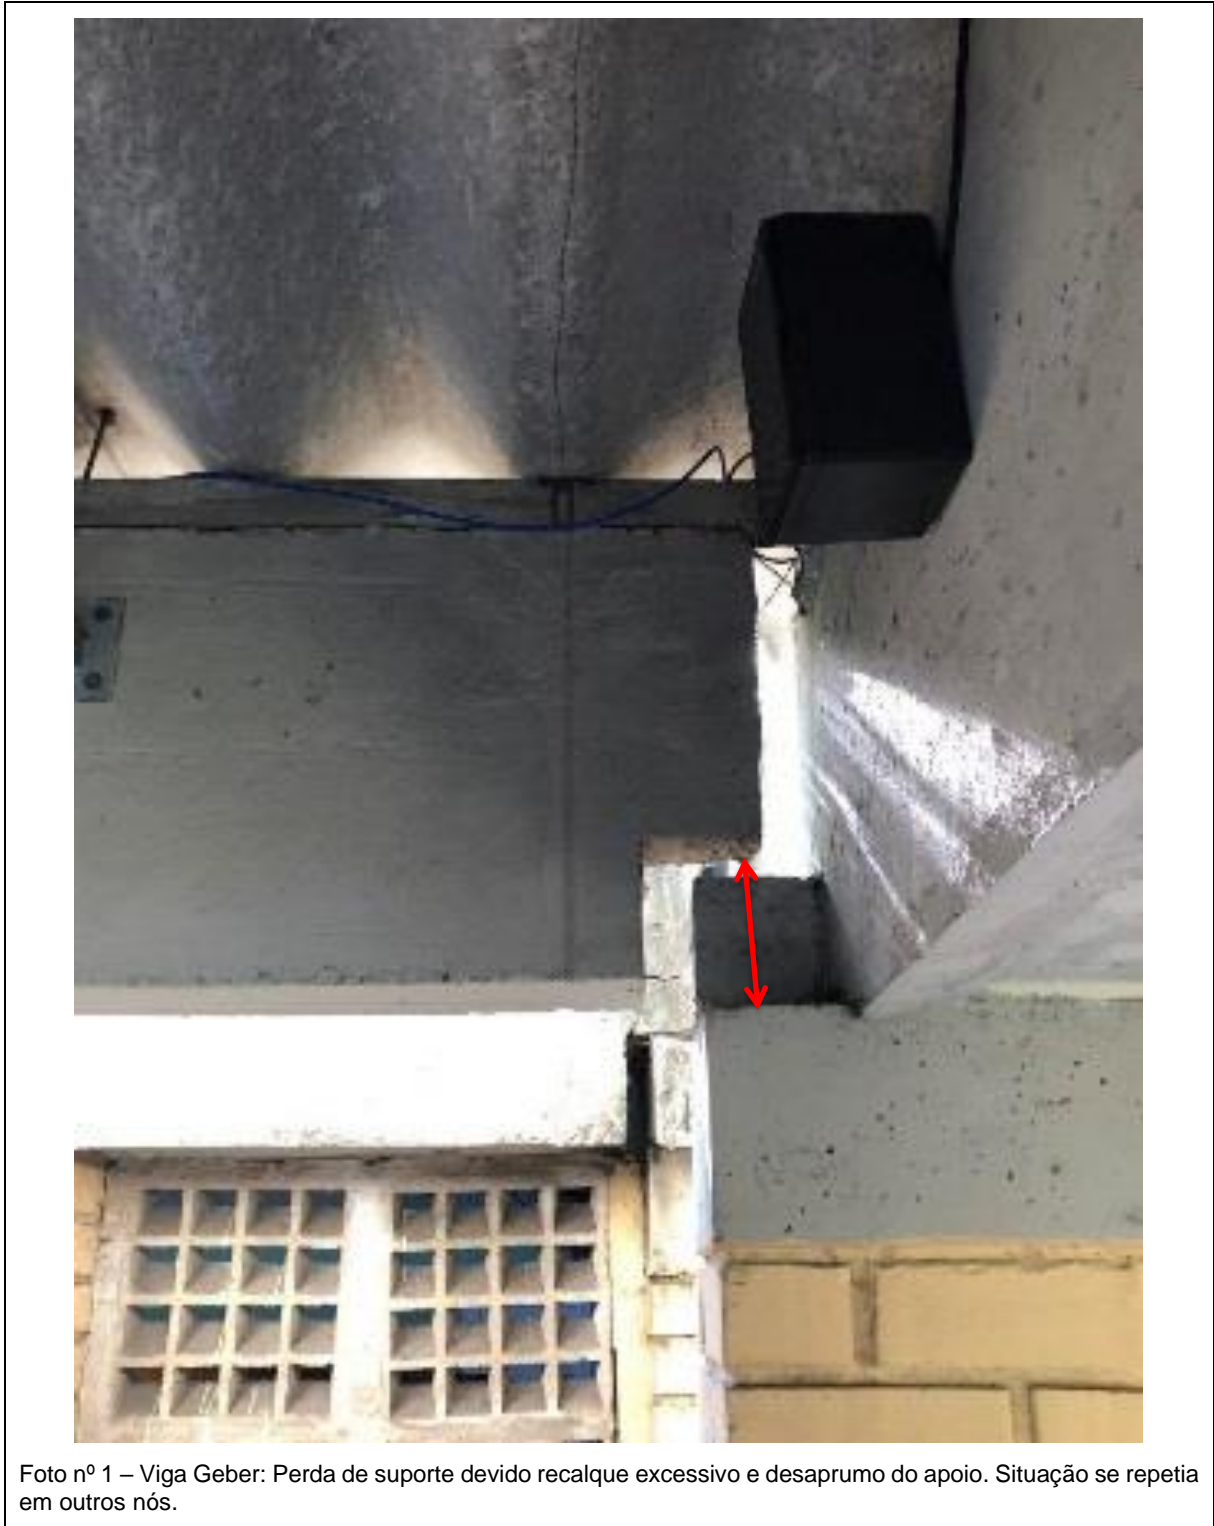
Viga Geber: Perda de suporte devido recalque excessivo e desaprumo do apoio. Situação se repetia em outros nós.
